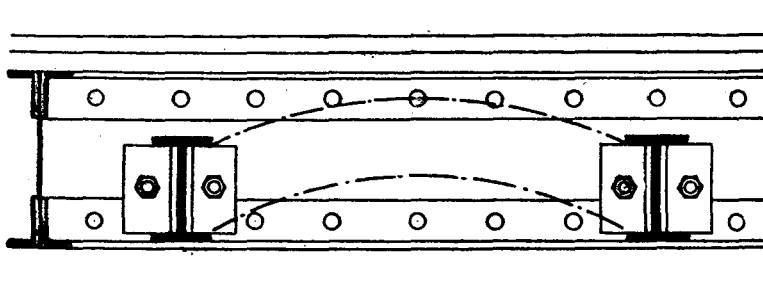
Ensambladura de las viguetas con la viga maestra: caso de bovedillas con piso de entarimado.
